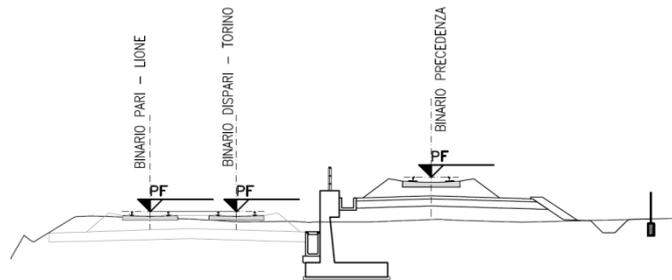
Sezione tipo configurazione in rilevato con muro di sostegno (piattaforma a schiena d’asino)
